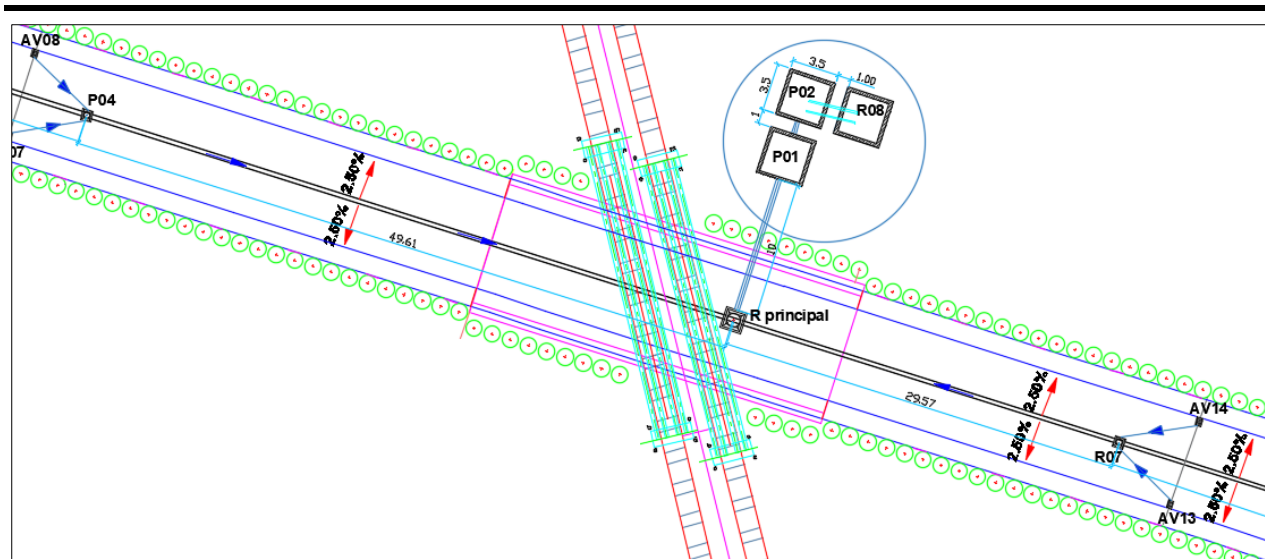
Plan d'assainissement de la partie couverte – centrale –
